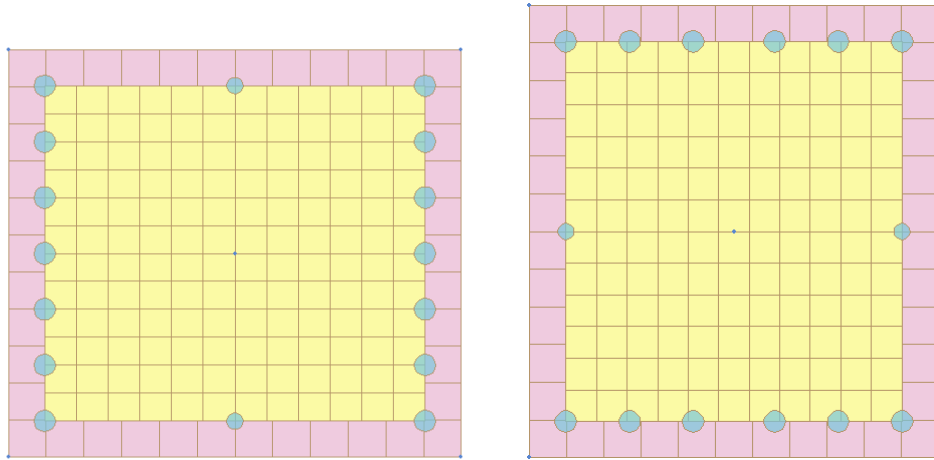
Sezione a fibre. Pilastro esterno e pilastro porta trave appoggia-pannello.
